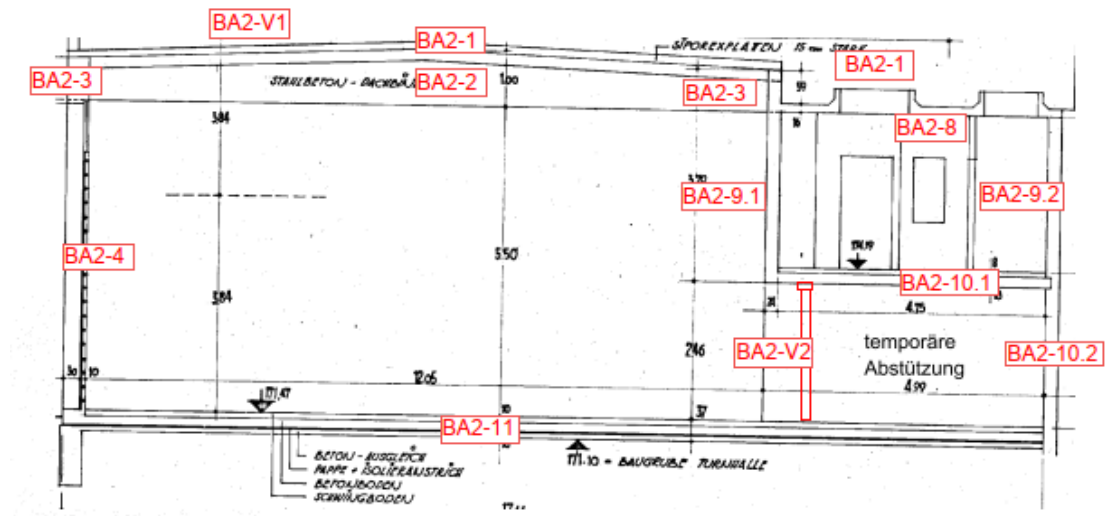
Rückbau – Prinzipdarstellung, Querschnitt Turnhalle, Ausschnitt Anlage 8
